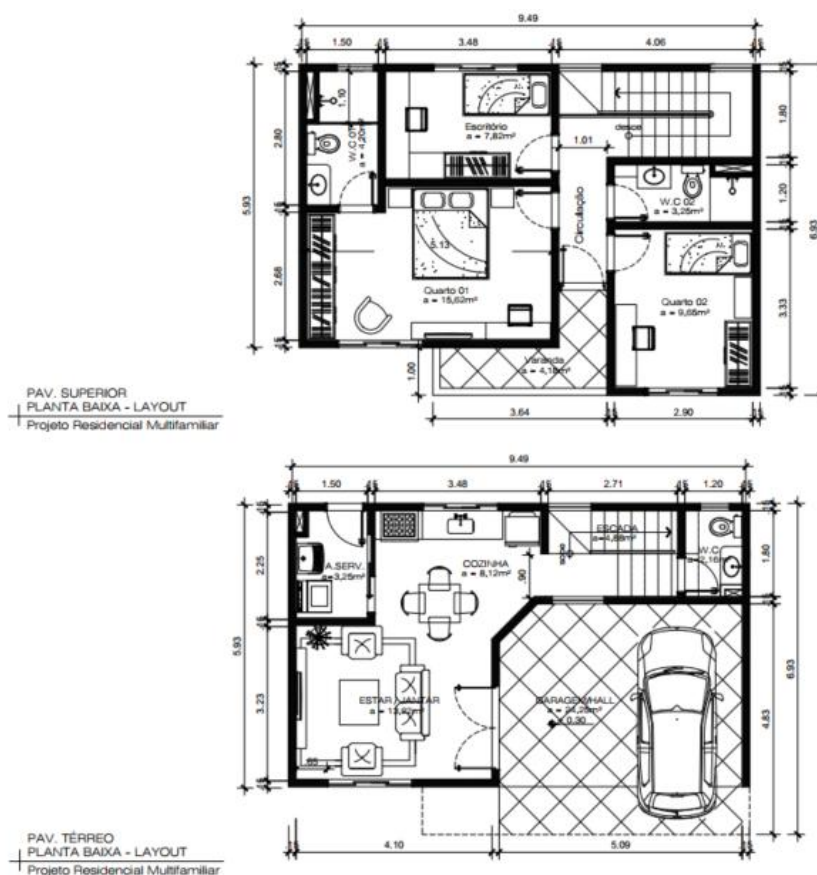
IMAGEM – PLANTA BAIXA DA UNIDADE (TÉRREO E SUPERIOR)
